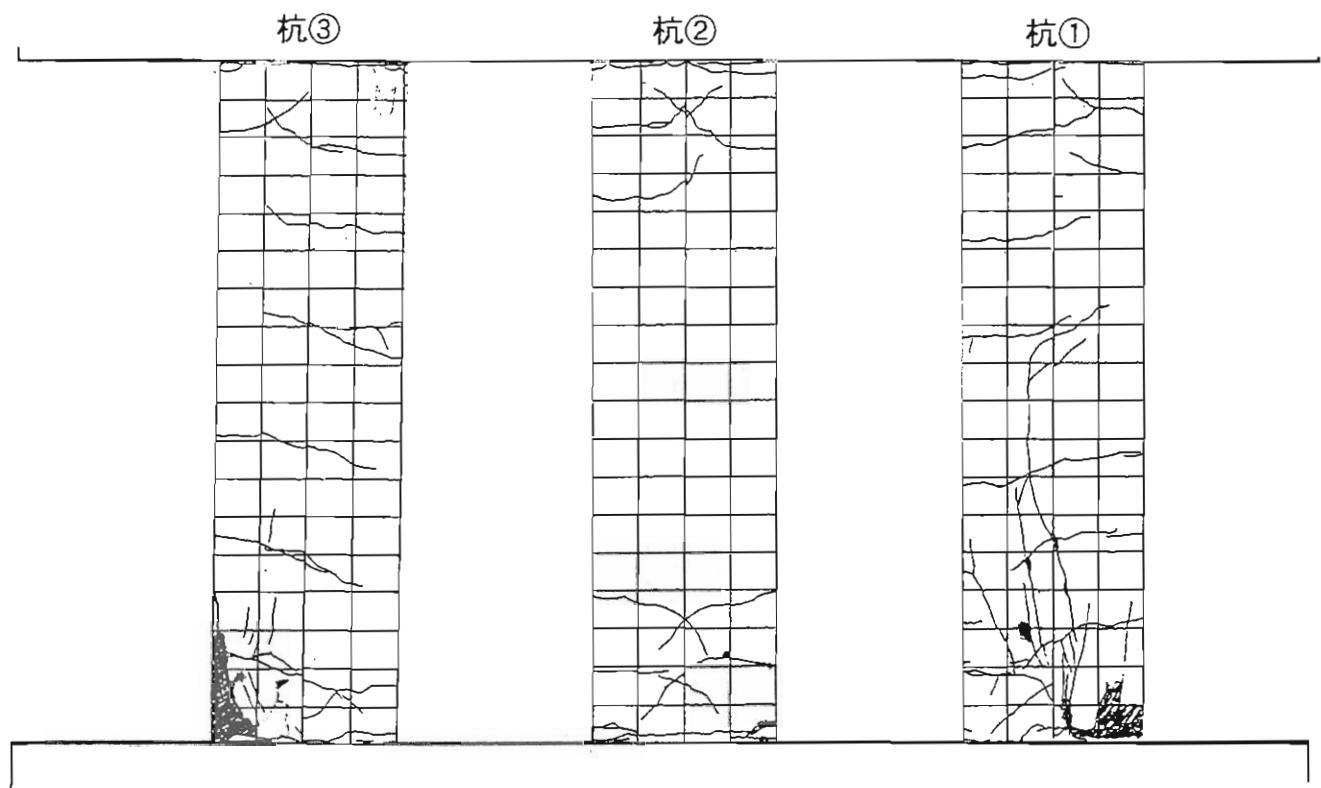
桁体のひび割れ状況展開図（ケース3、4 δy）
